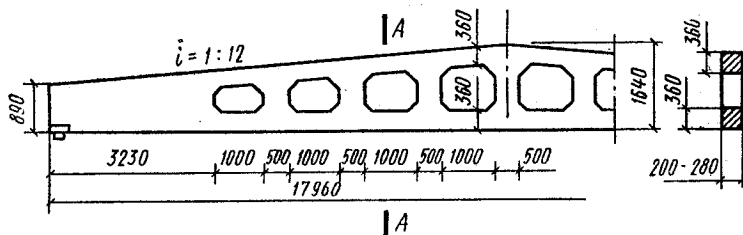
Двускатная решетчатая балка покрытия прямоугольного сечения пролетом 18 м
